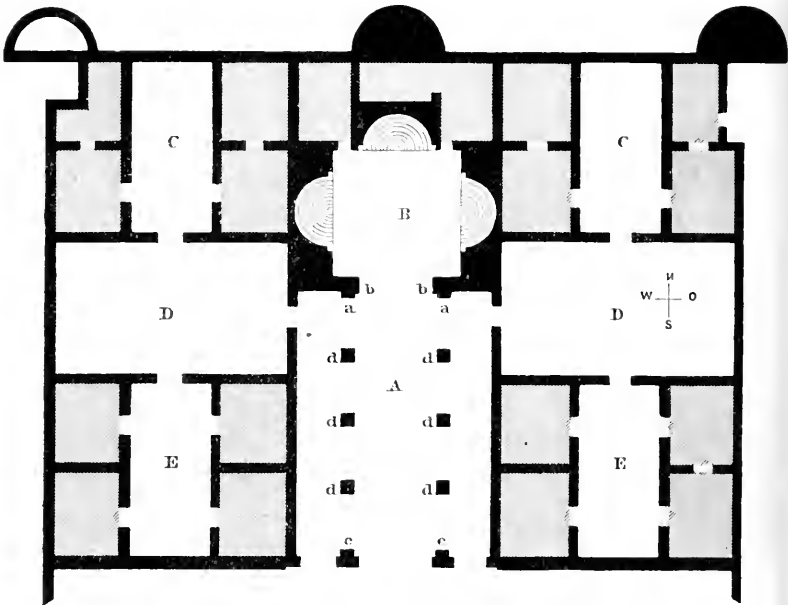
Grundriss des inneren Palastes in Mescheta.
